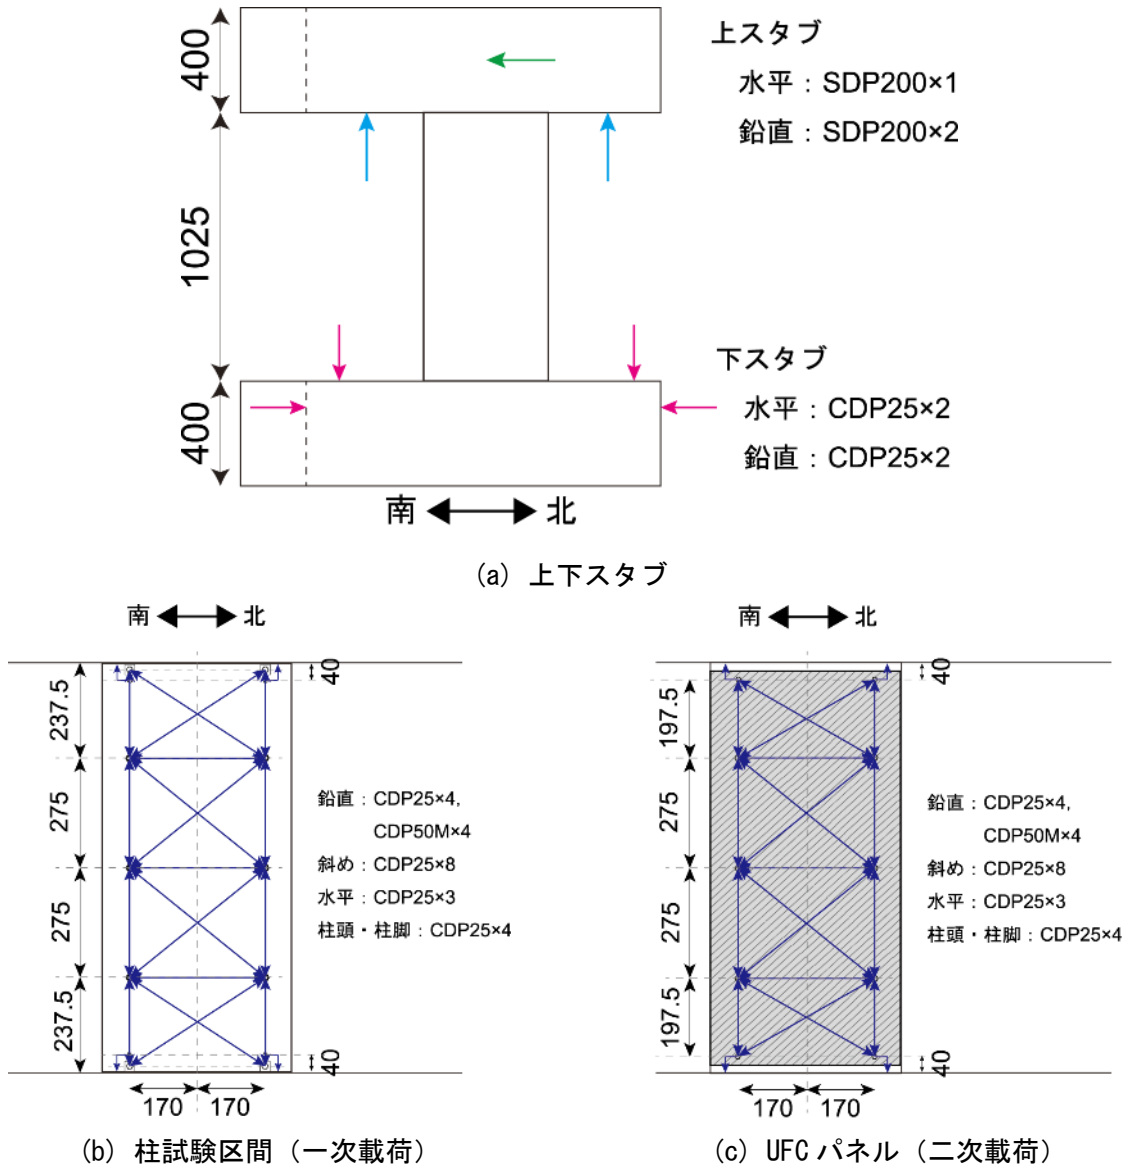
変位計取り付け位置図 (東面図) (単位 : mm)
